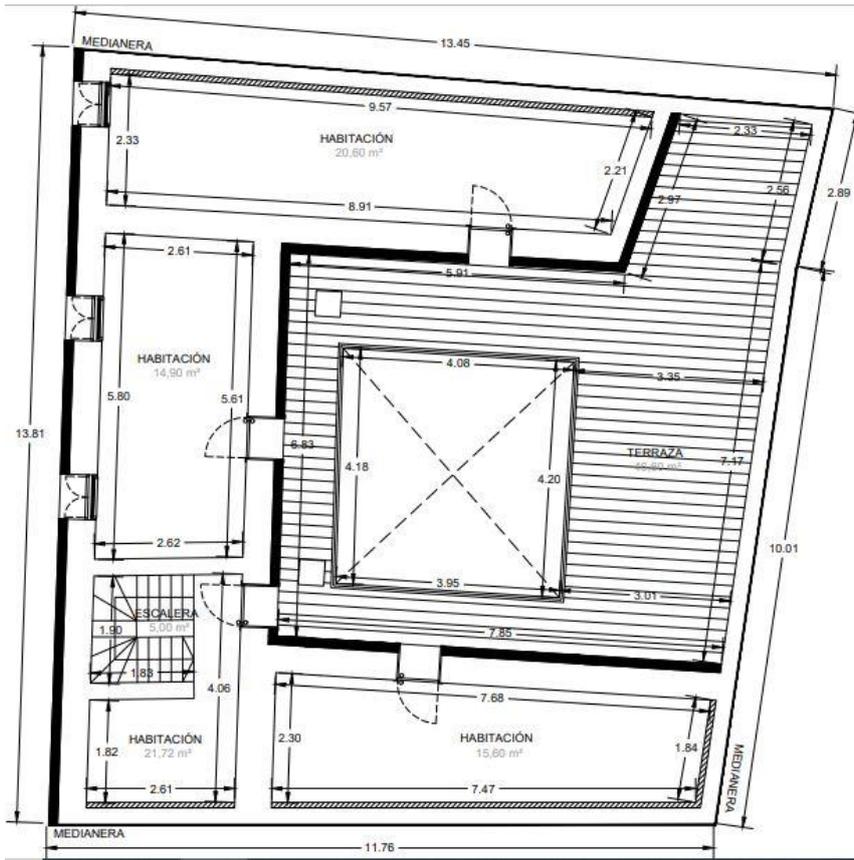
Plano planta segunda del edificio (Elaboración propia)
